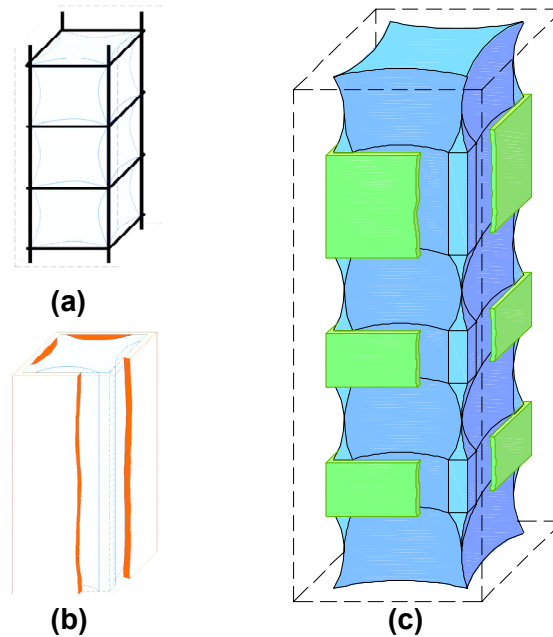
Confinamiento impuesto por: (a) Armaduras transversales; (b) Refuerzo con chapa continua; (c) Presillas metálicas (SHARAPM)
